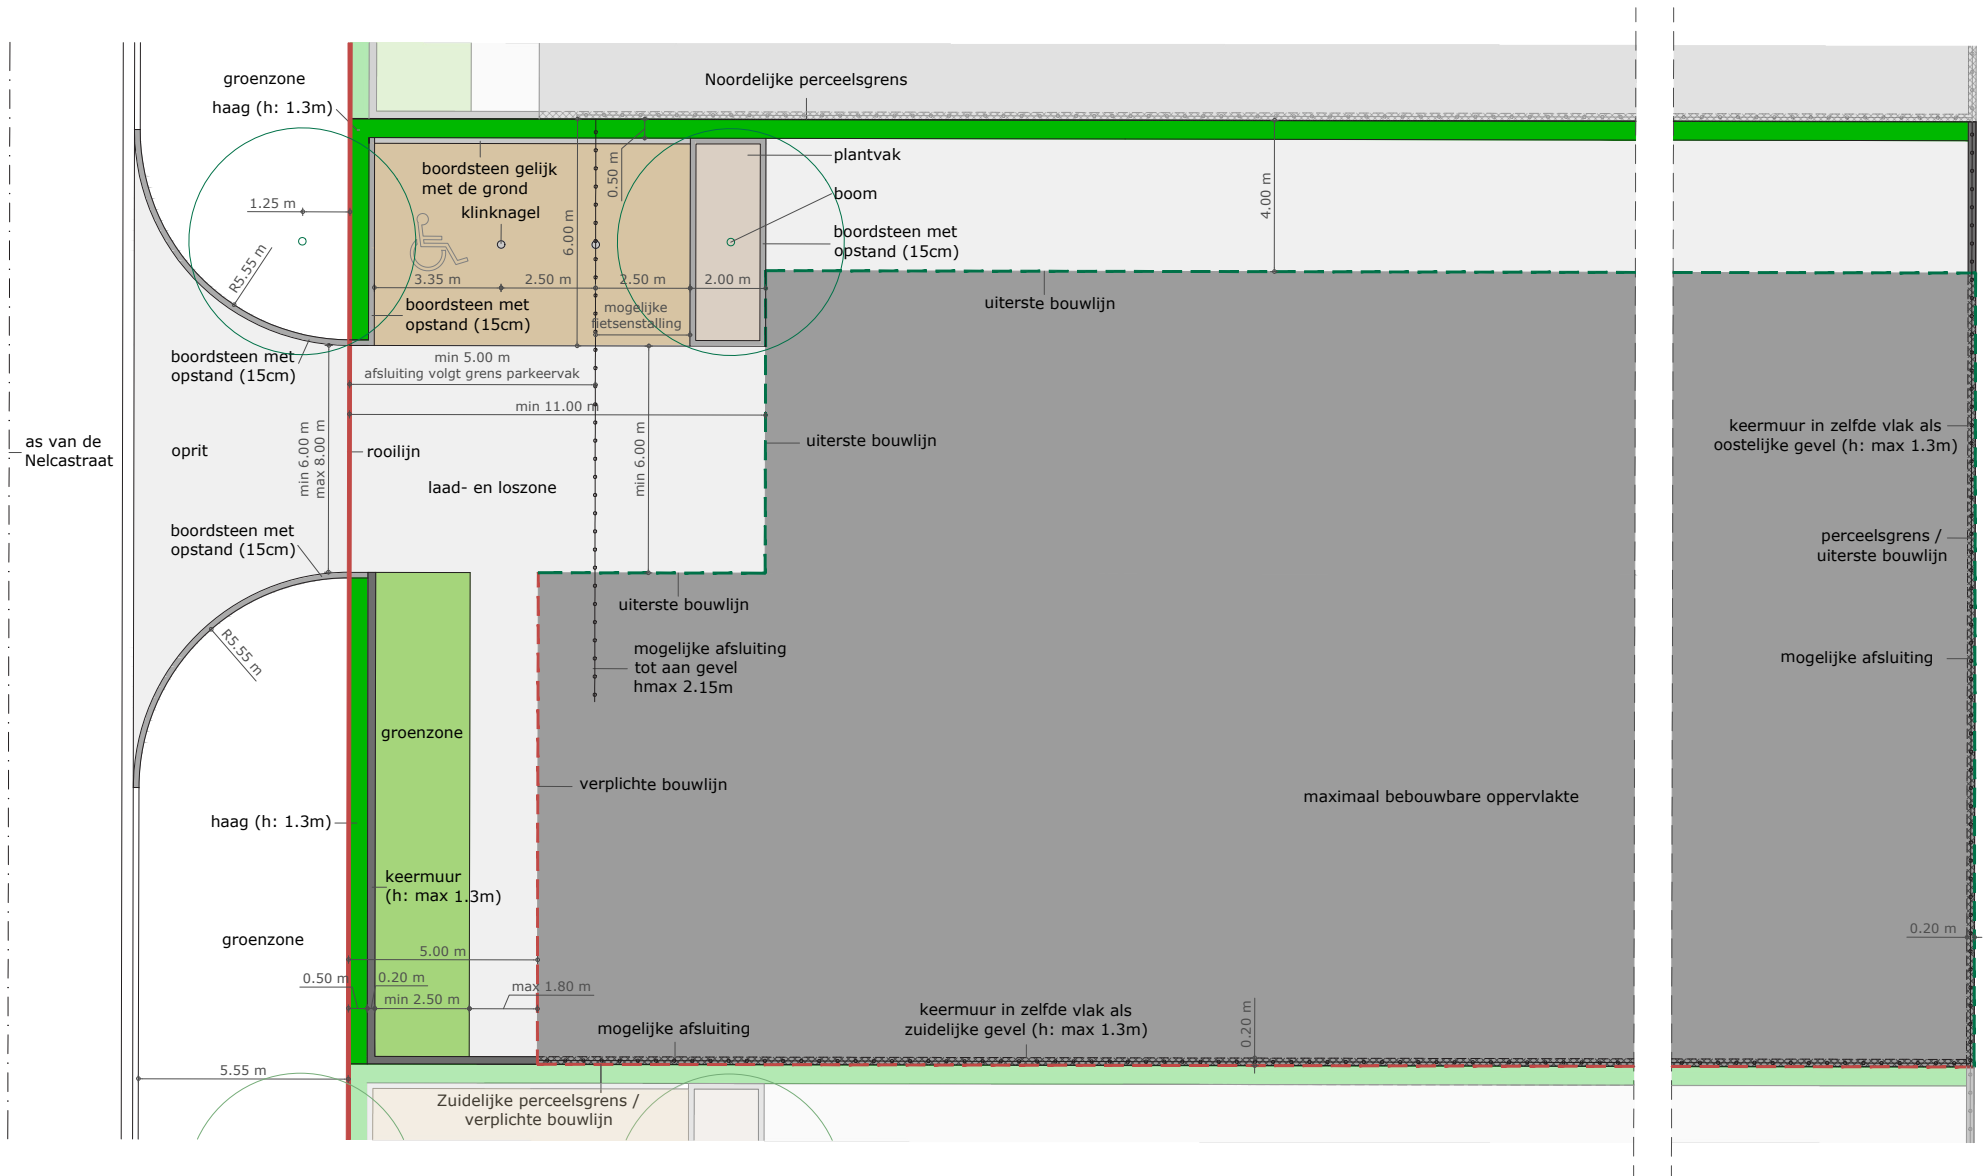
DETAIL PERCEEL NELCASTRAAT - VARIANT WEST
